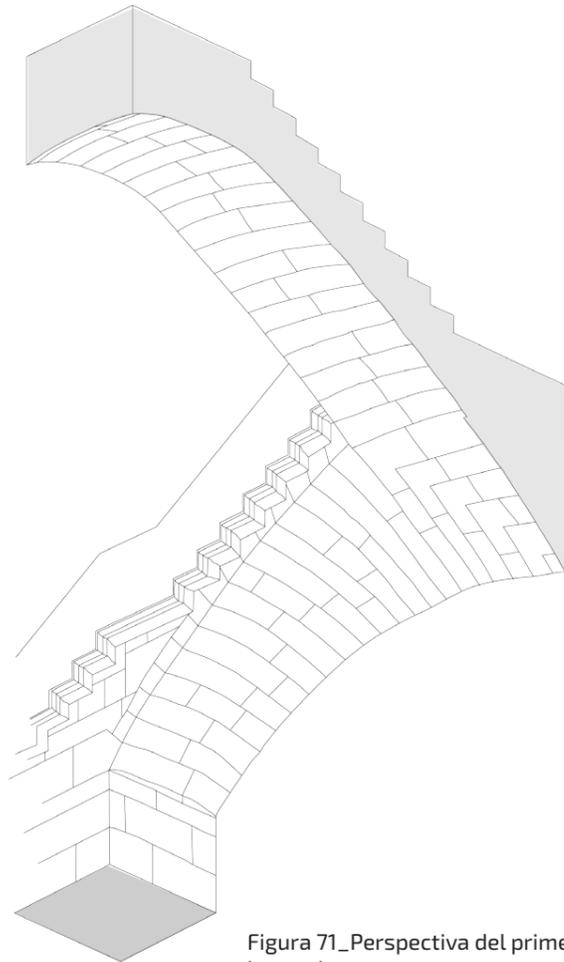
Perspectiva del primero y segundo tramo de la escalera
